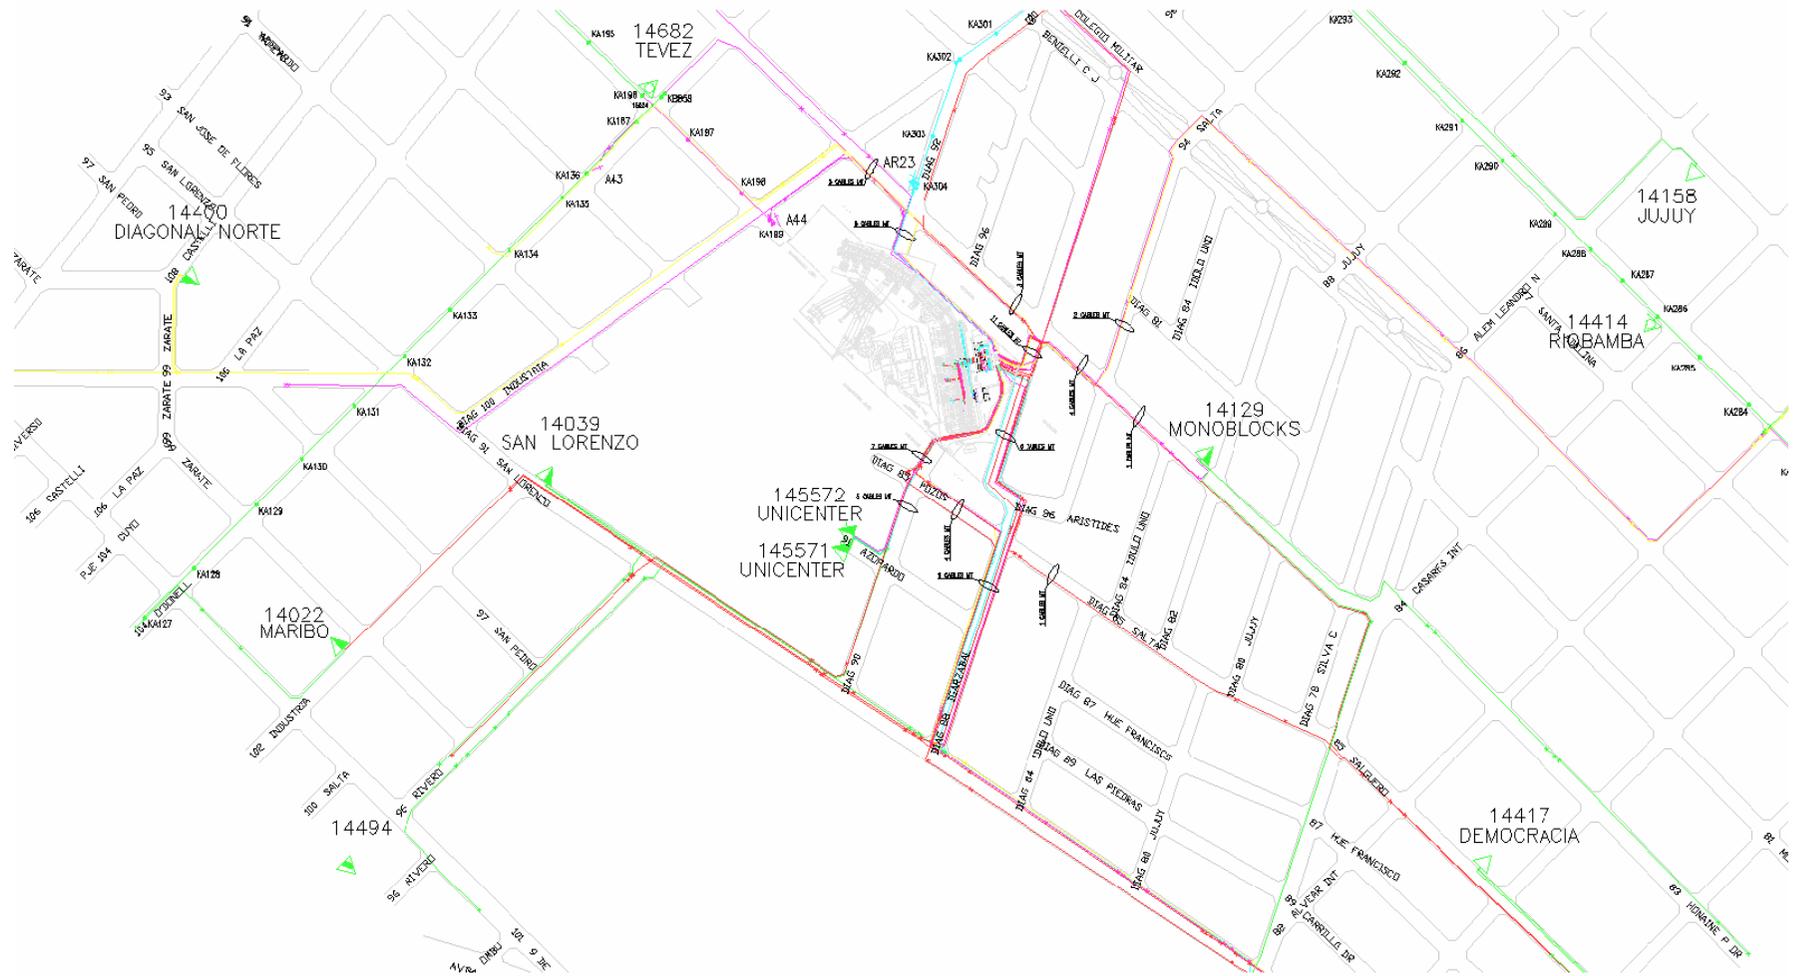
Equipos de Media tensión. Planta. Tendido de cables de 13,2 kV.
